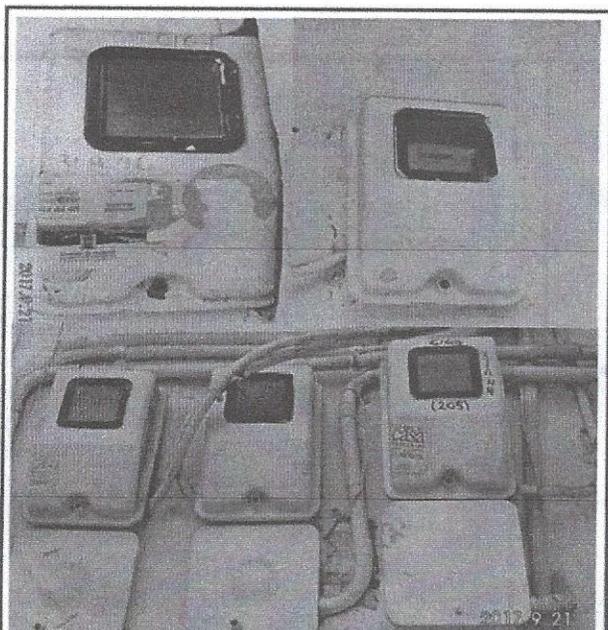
CONTADORES VIVIENDAS POR CALLE 67
